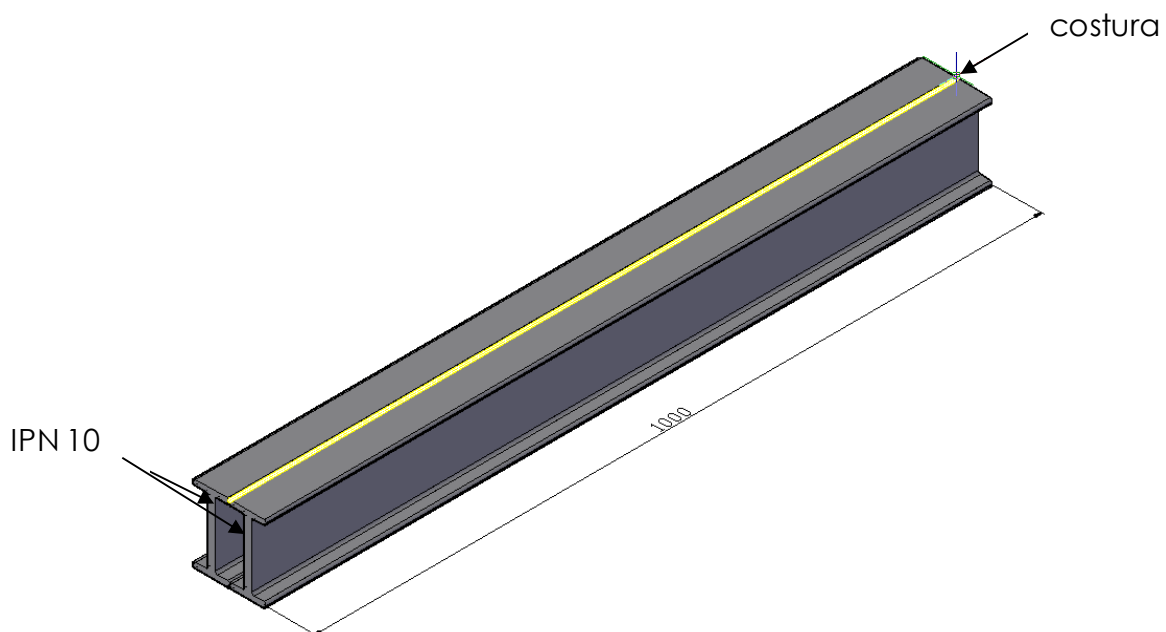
3. Dispositivo rigidizador (dimensiones en mm).
